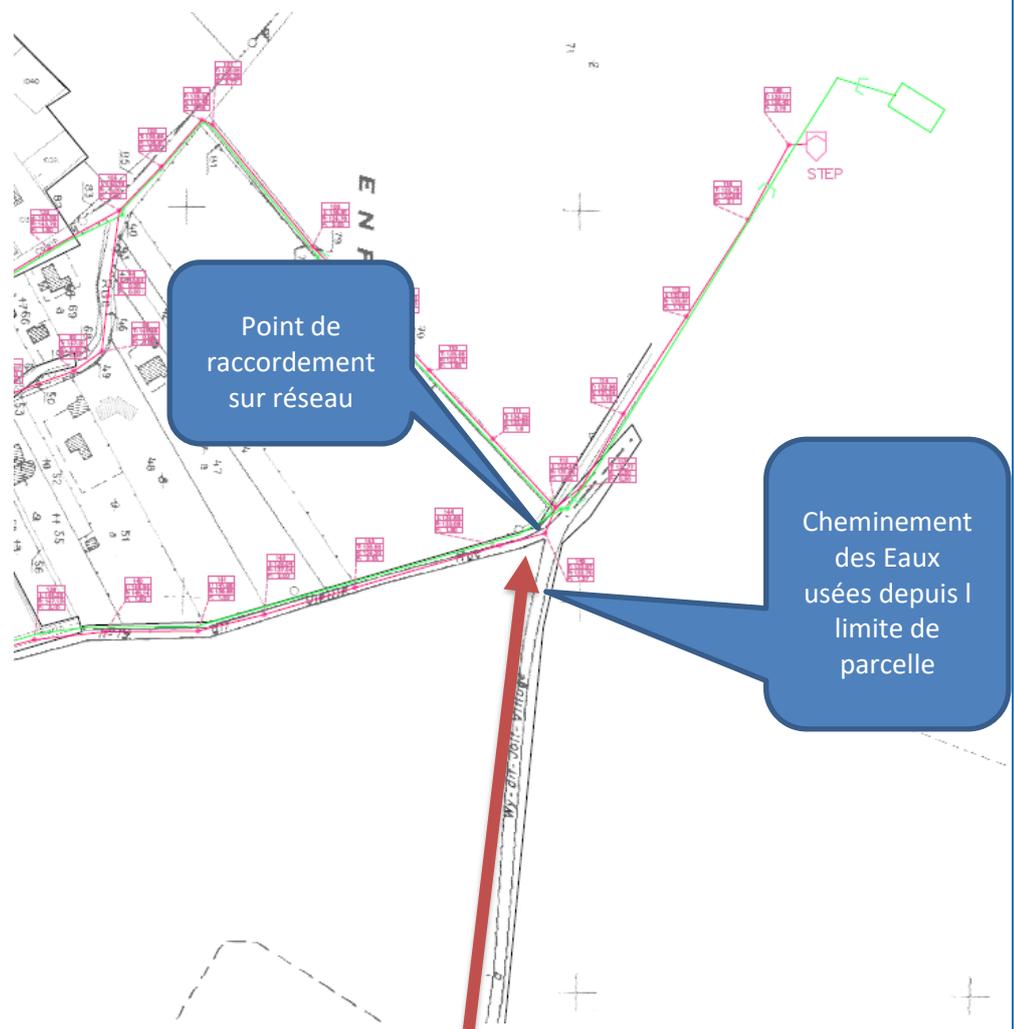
Plan de raccordement du château de Hazeville au réseau d'assainissement collectif
